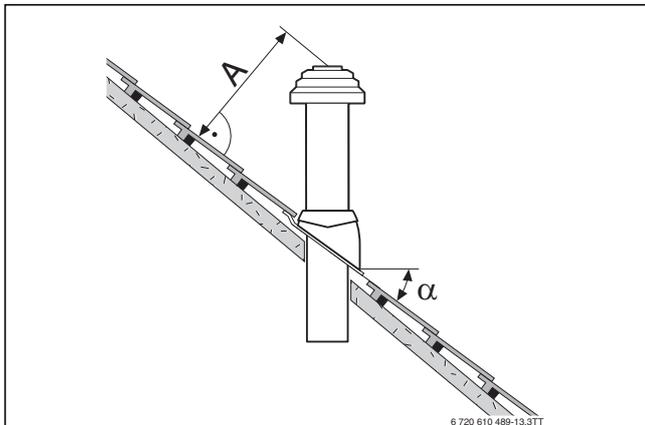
Abstandsmaße und Dachneigungen bei Schrägdach
